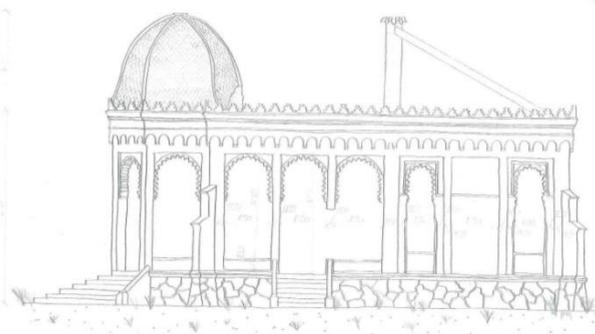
Croquis Alzado Sur (2014) - Fuente propia
